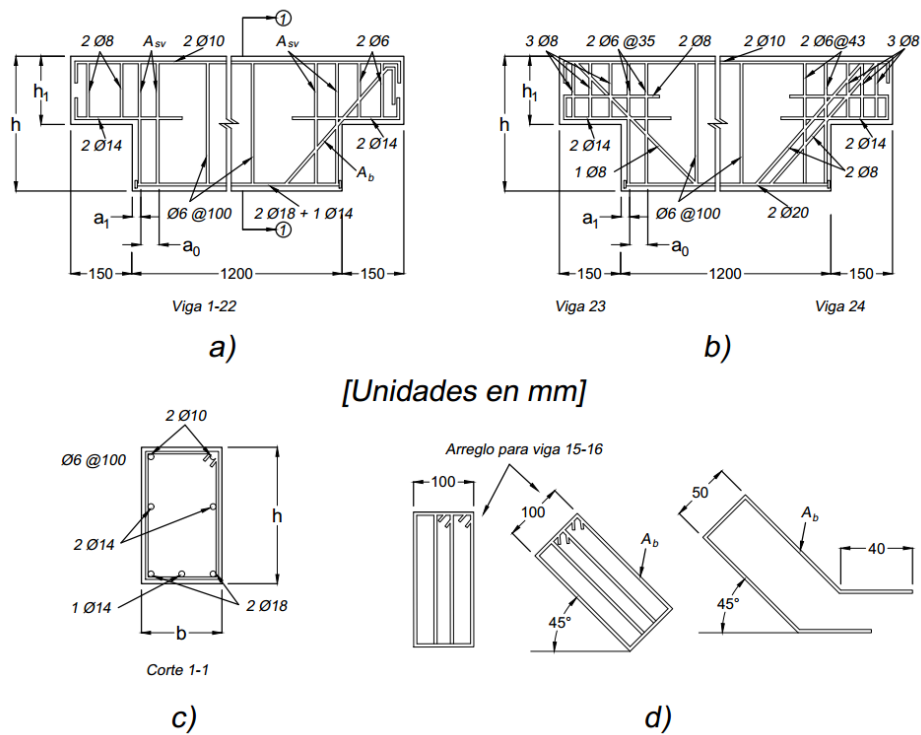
Geometría del espécimen y detalle del refuerzo. (Wang et al., 2005)
